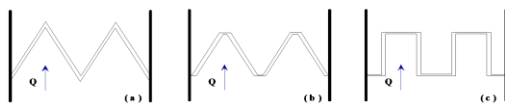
Forme en plan du déversoir en labyrinthe (a) - triangulaire, (b) - trapézoïdale (c) – rectangulaire.
